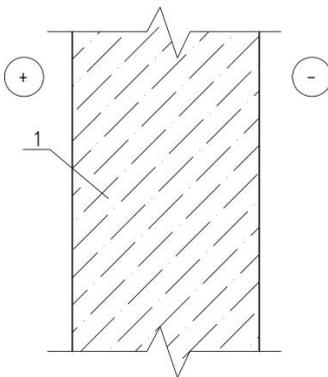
Пример однослойной стеновой конструкции. (1) - газосиликатные блоки
